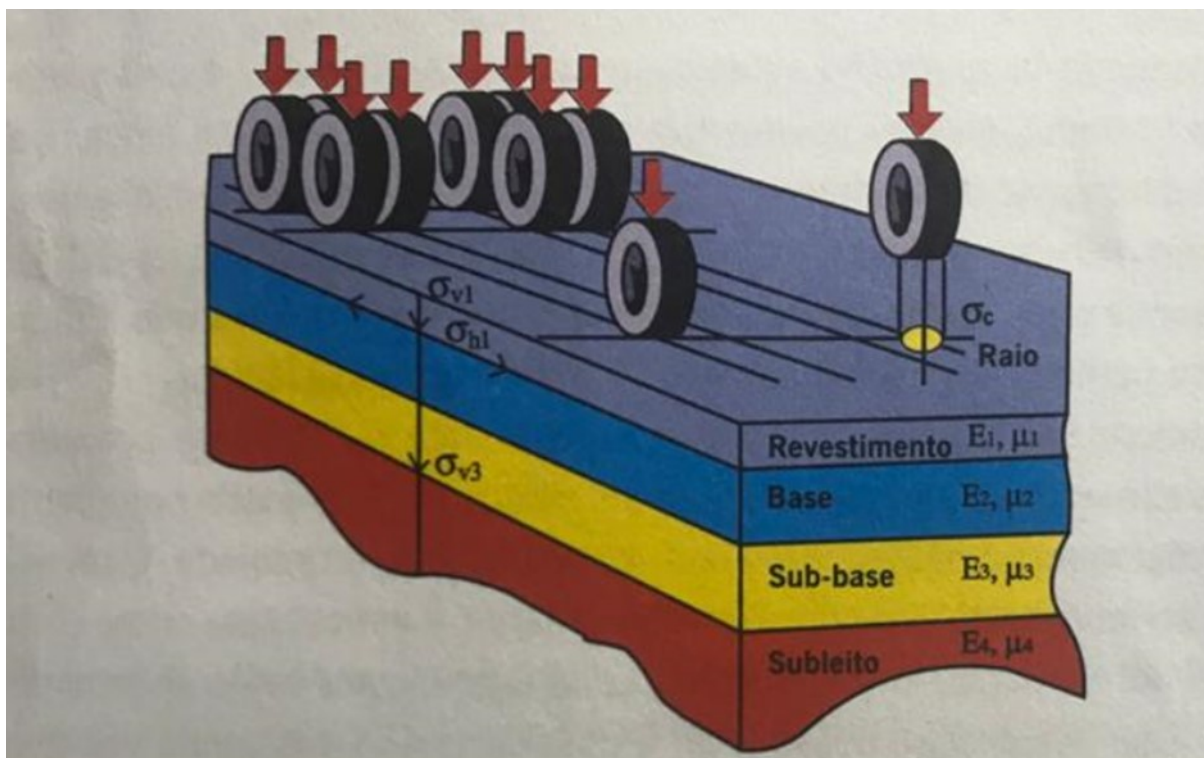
Ilustração do sistema de camadas de um pavimento e tensões
